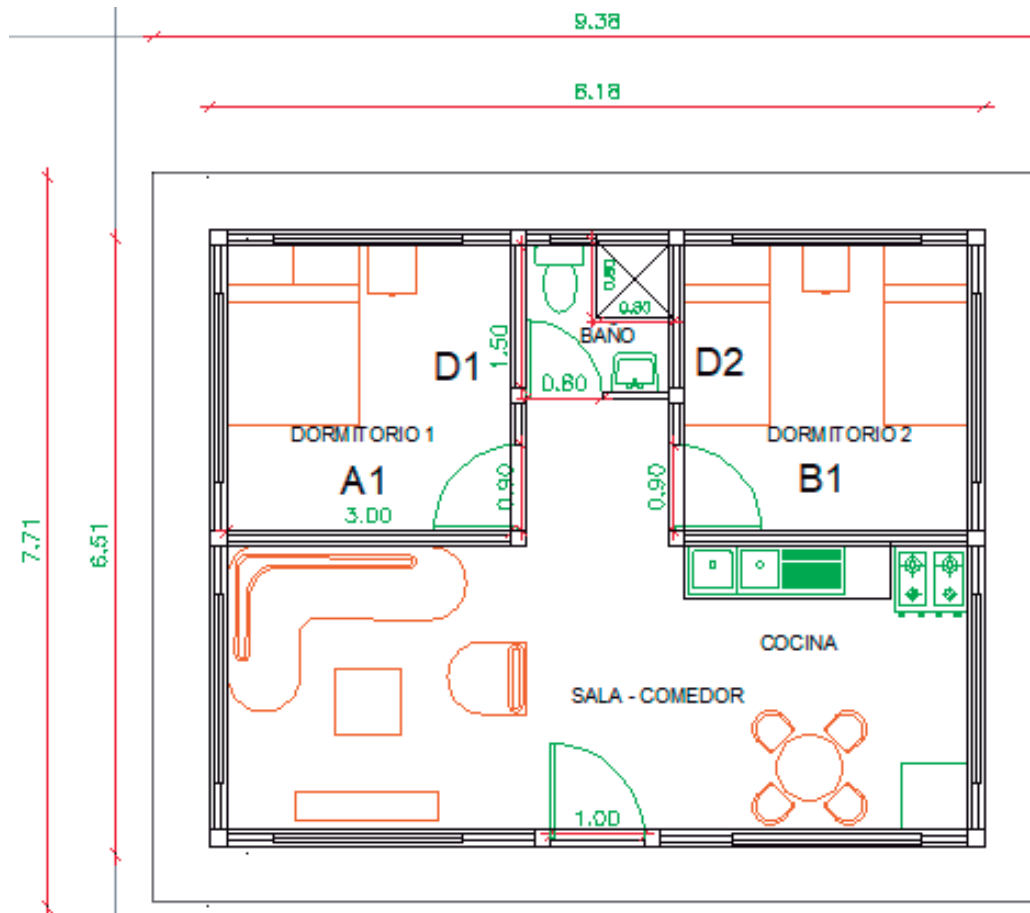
Armado tipo lego de vivienda en un área de 53.25m², sobre una placa de hormigón de 72.32.m² - AutoCAD, 2018
